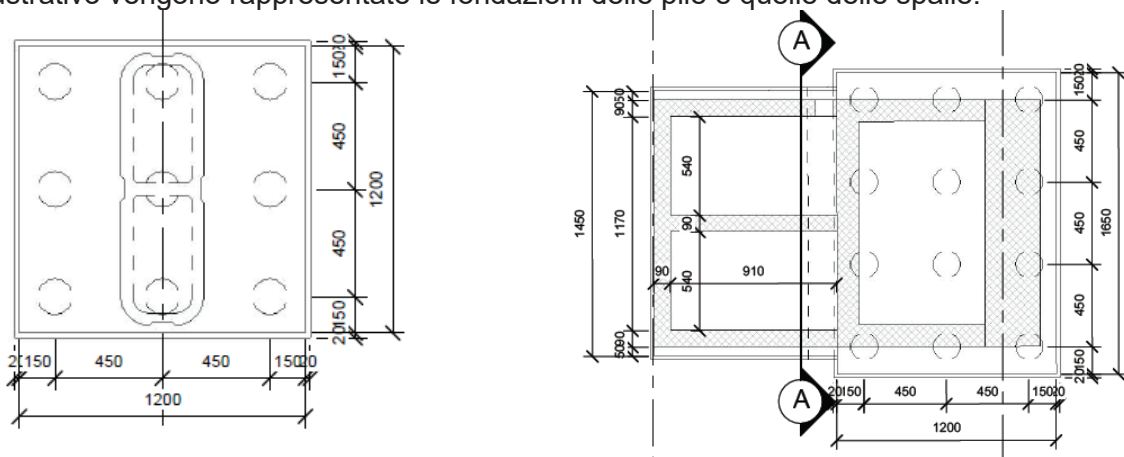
Pianta delle fondazioni delle pile e delle spalle
